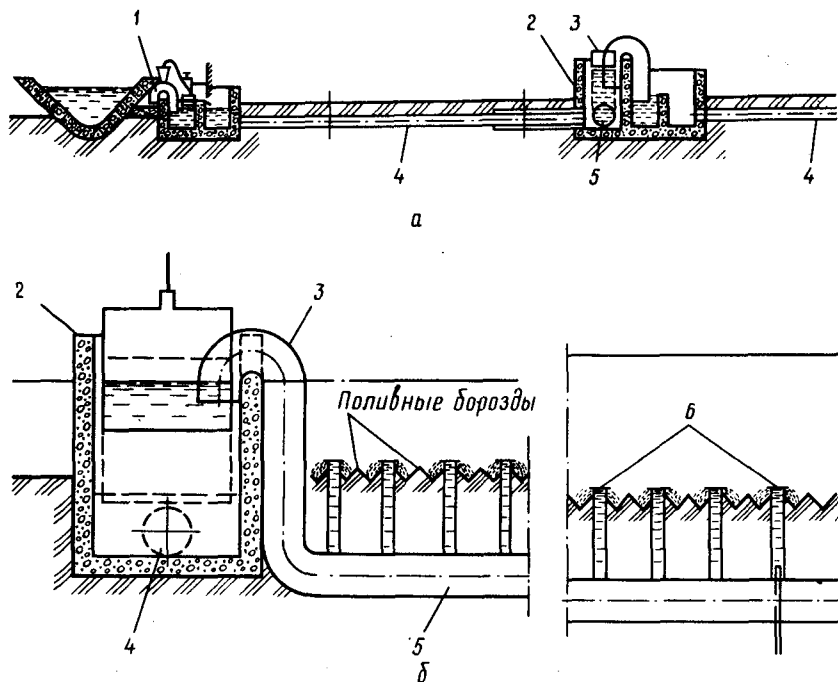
Расчетные схемы закрытых трубопроводов:
